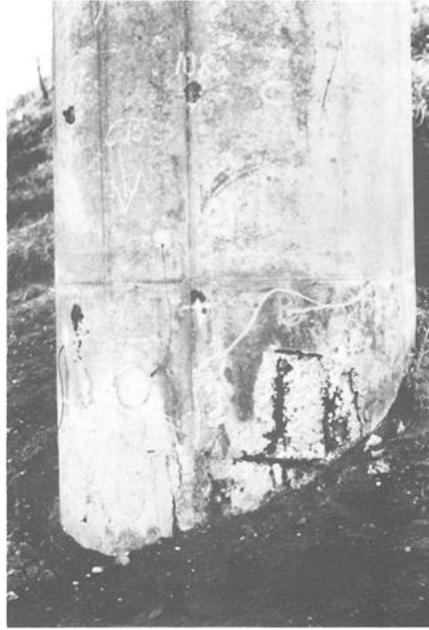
Corrosión del acero en la base de la columna (Harding et al., 1990)
